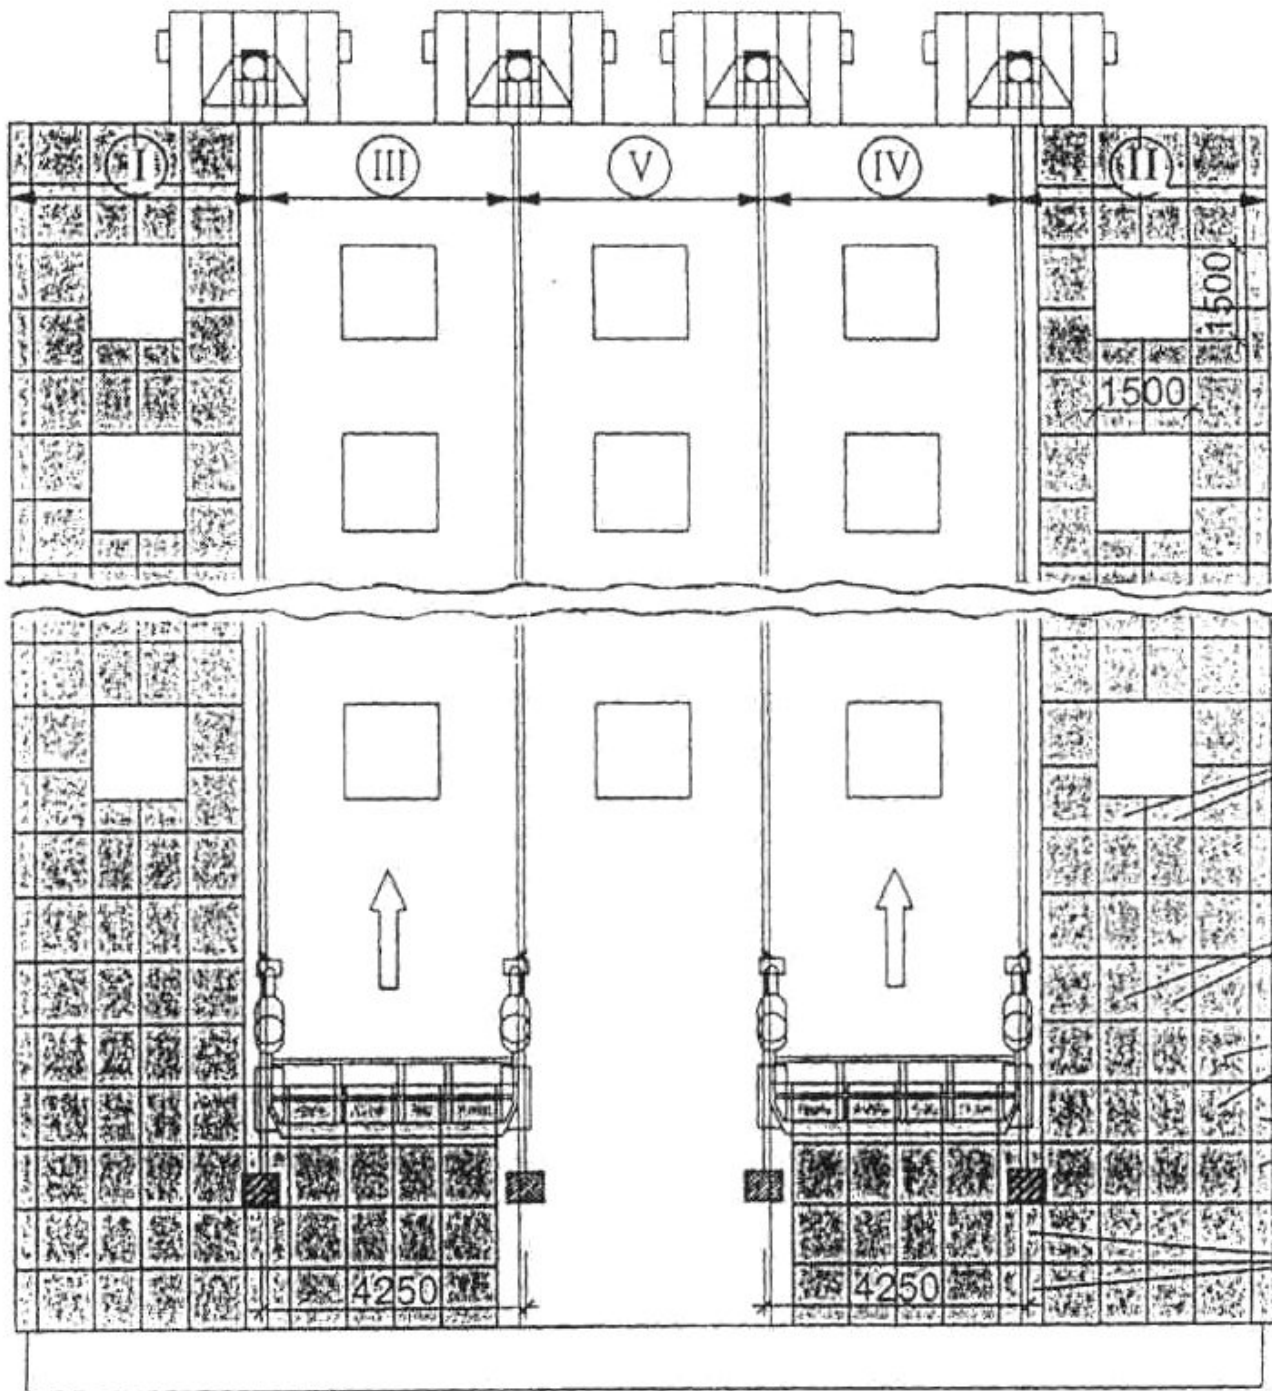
Схема утепления фасад здания, где I, II, III, IV – номера захваток
